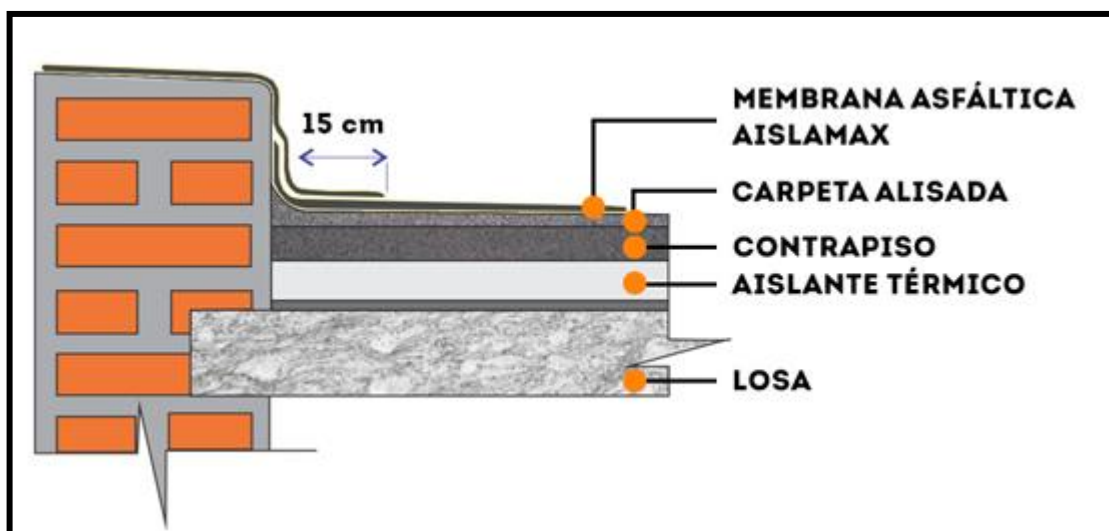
Detalle de colocación de membrana asfáltica en losas macizas
